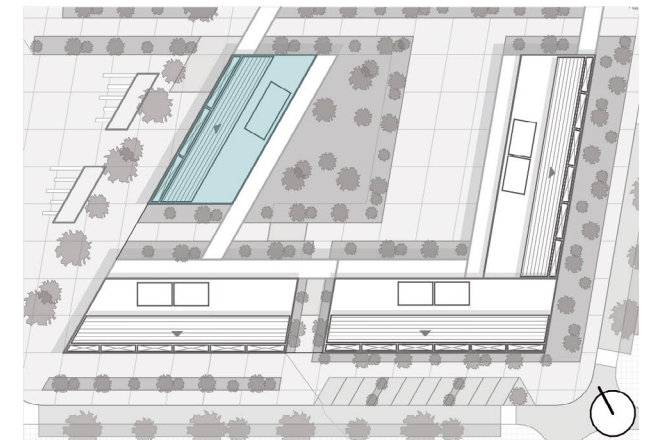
| Planta Alta | Fuente: Autoría propia. (2023).
